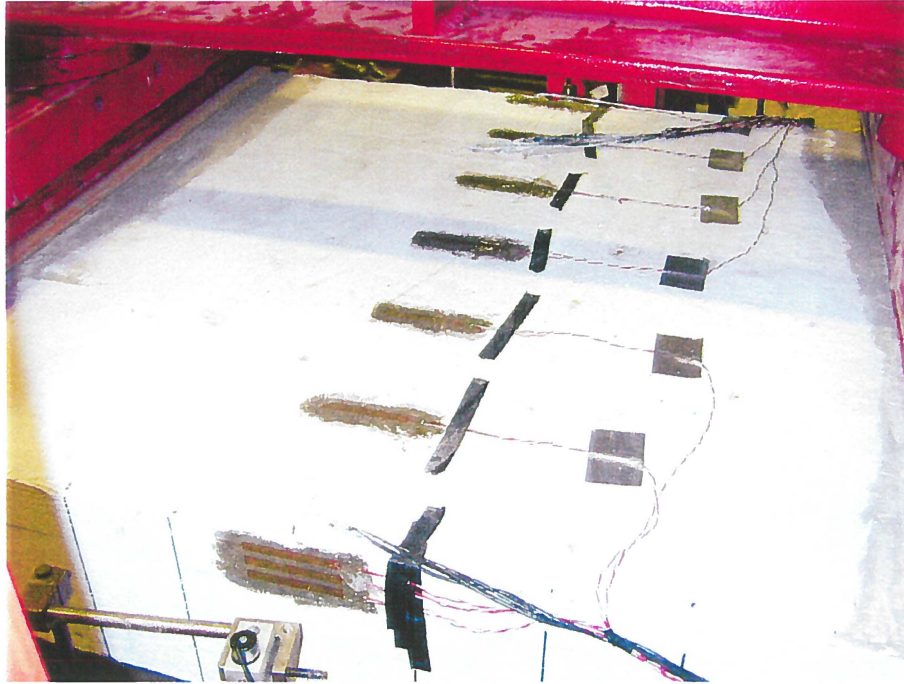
Vue de l'instrumentation de la face comprimée du béton des dalles
